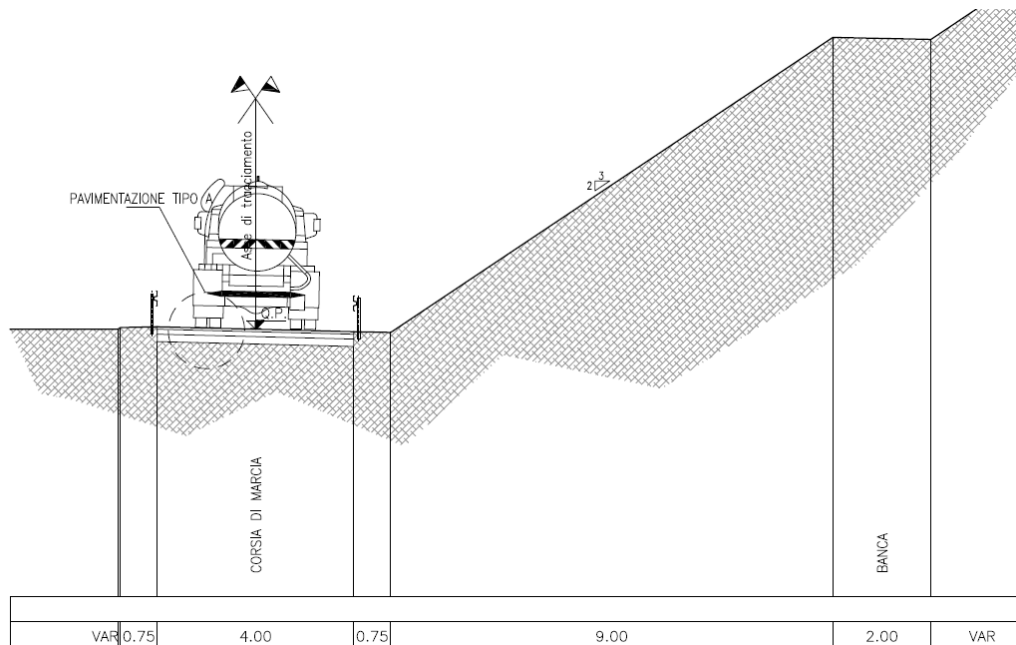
Sezione tipo strada di cantiere/security (in scavo con banca)
